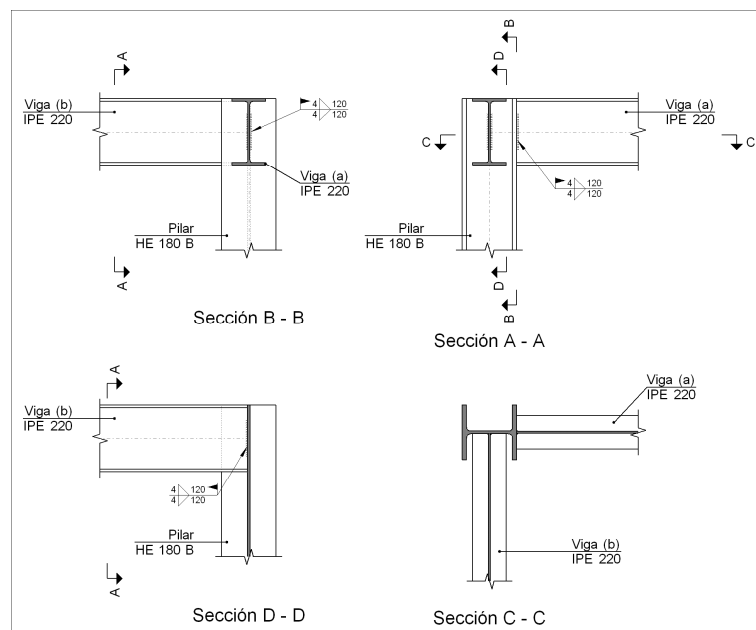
Detalle de las soldaduras tipo 4 del soporte inferior
